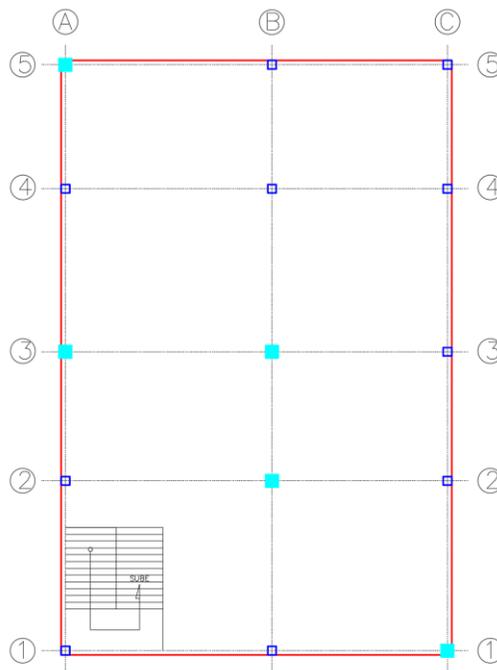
Ejes de Columnas_Fuente: Jose Vega L.
